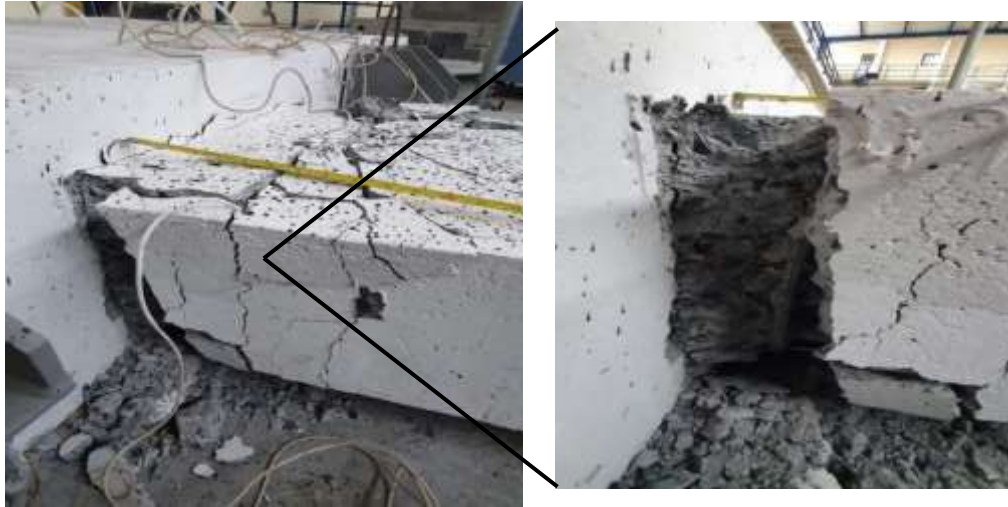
Vista en planta de la viga sin fibras de acero.
